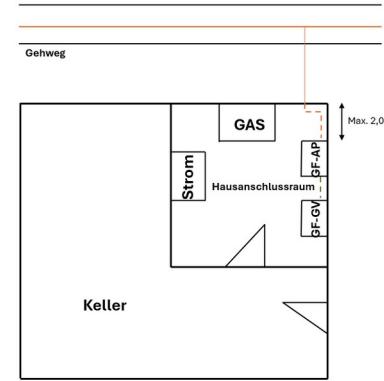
Plano del sótano con sala de conexiones (Variante 1)
